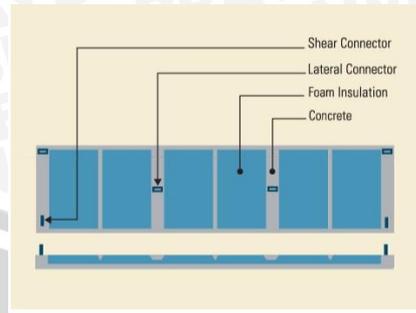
Precast Facade* terhadap thermal bangunan
